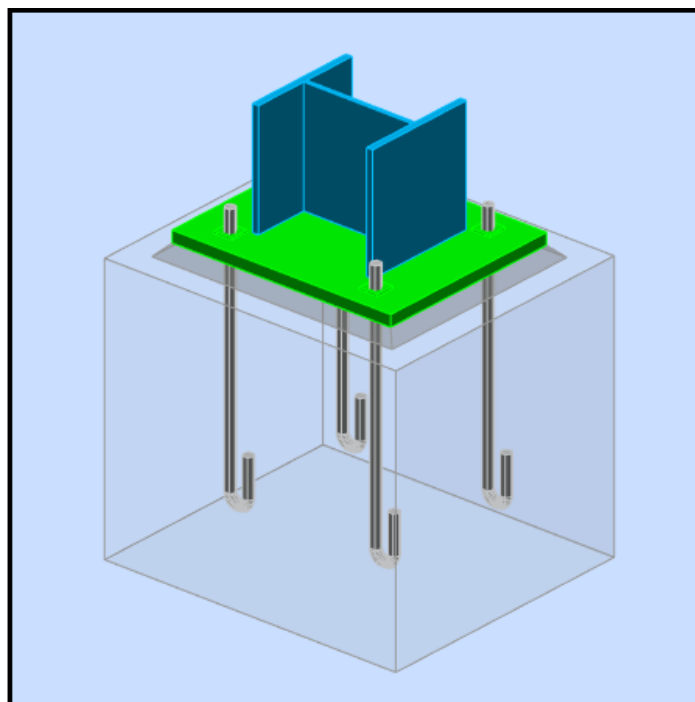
Vue 3D de l'assemblage pied de poteaux.
